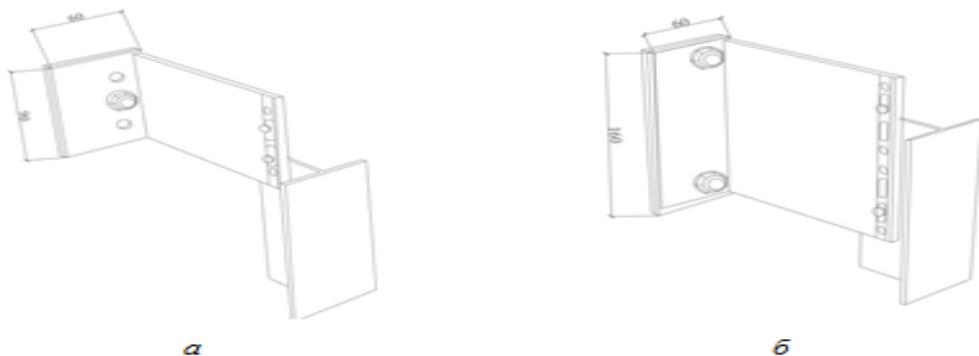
Конструктивні варіанти кріпильних елементів вентиляованого фасаду: а – кронштейн на половину висоти, б – кронштейни на повну висоту
